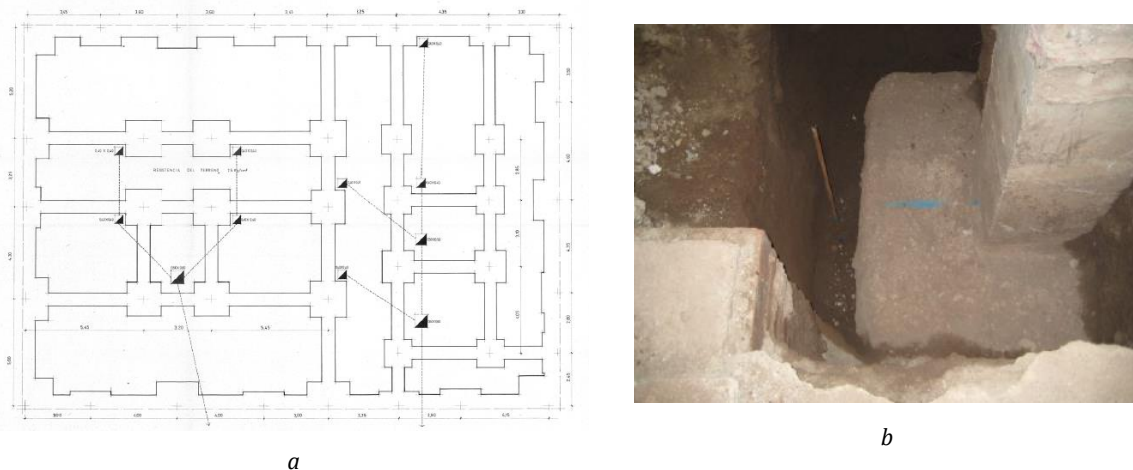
Edificio La Viña (lorca). Planta de la cimentación del edificio y detalle de las calicatas en la cimentación (fuente: Ratzlaff, 2011)
